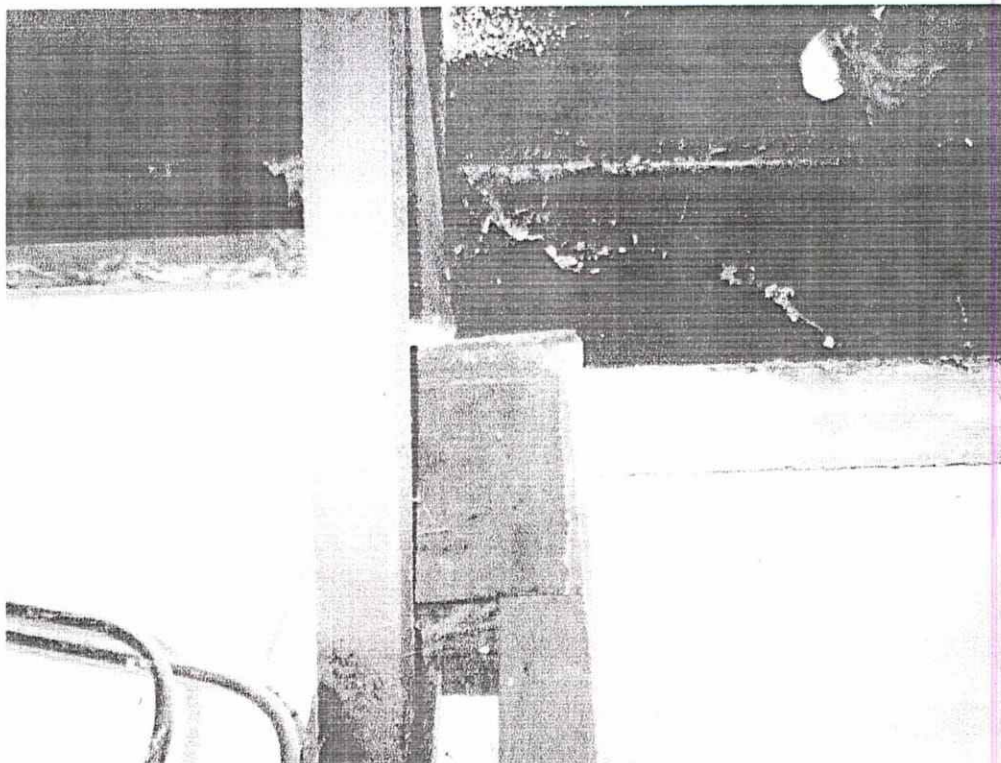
Коррозия металлических балок перекрытия антресольного этажа.
